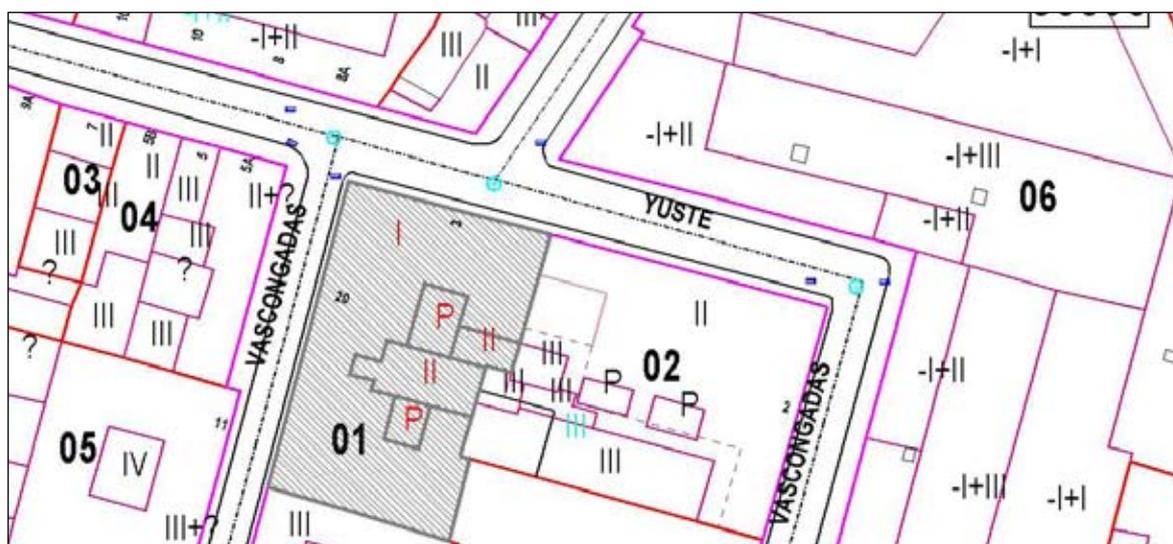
Parcela del solar nº3 de la Calle Yuste en la planimetría catastral (Fuente: GMU de Sevilla).
